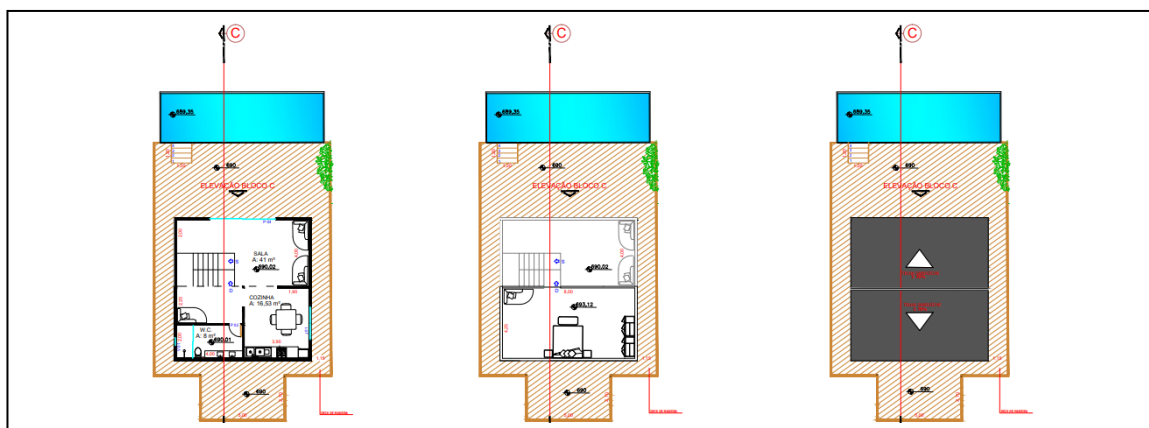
Planta baixa térrea e mezanino e planta de cobertura da tipologia *A-frame House
